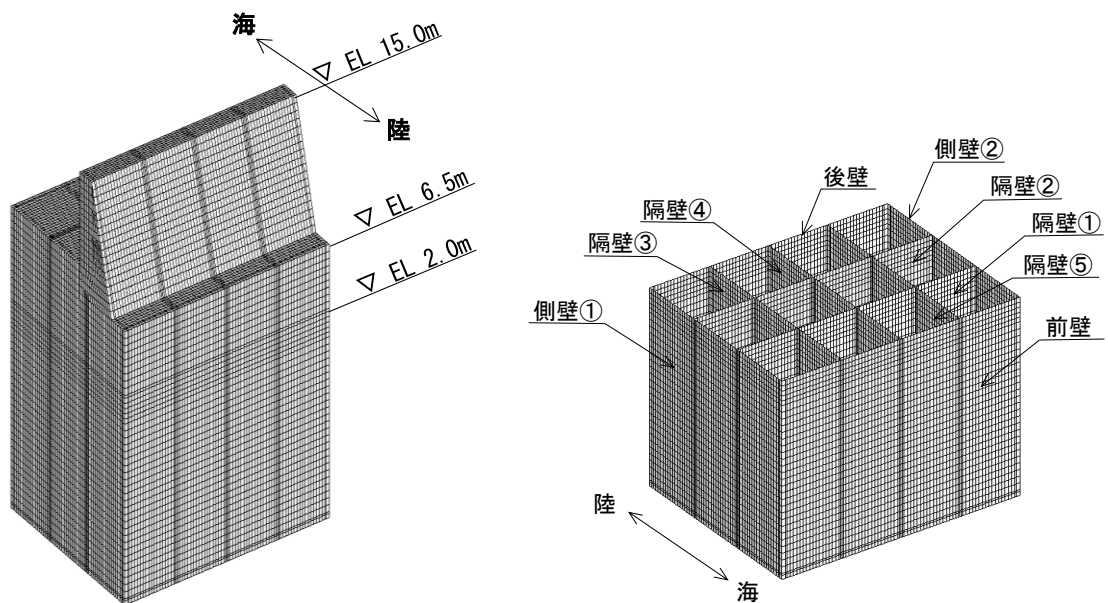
(2) 評価対象位置図 (④-④断面)
